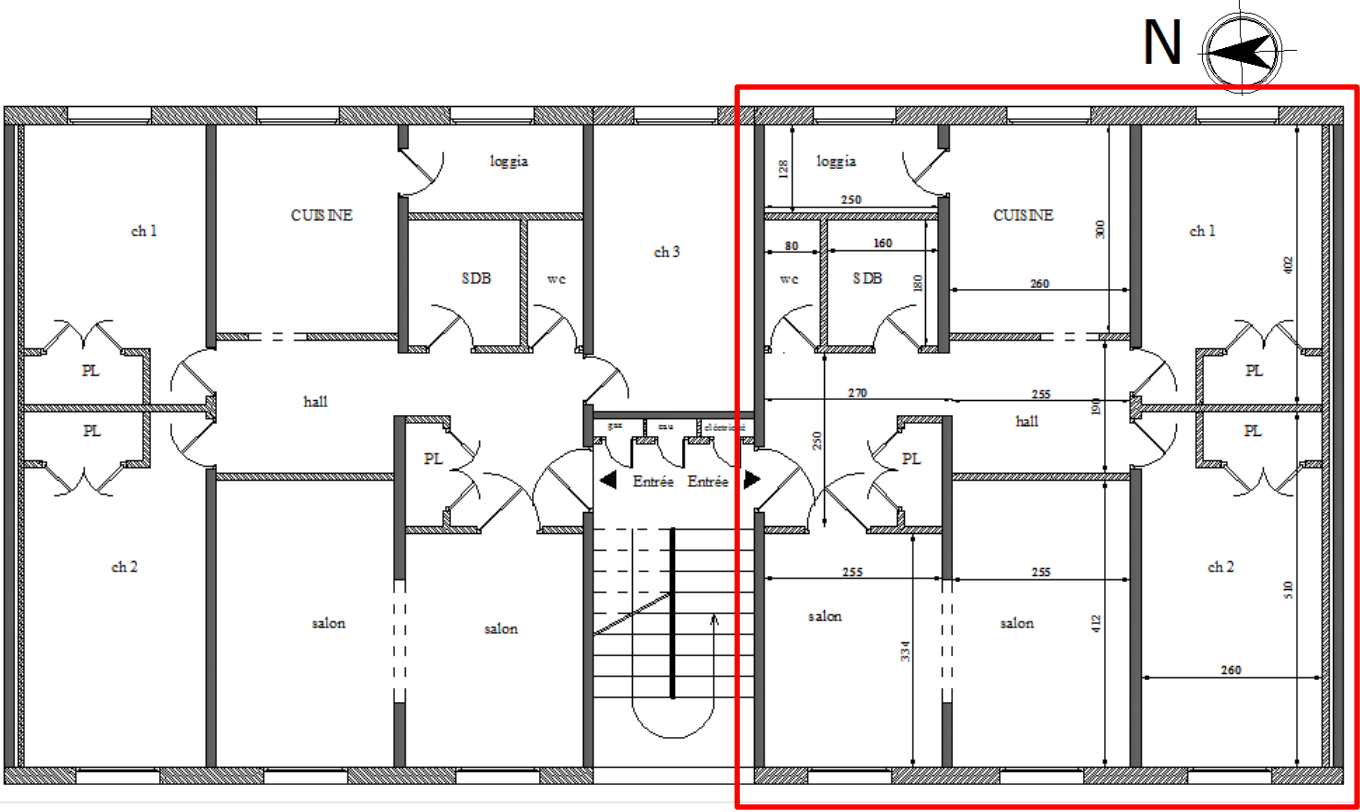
Plan de l'appartement (source: Dessin par AUTOCAD effectué par l'auteur)
